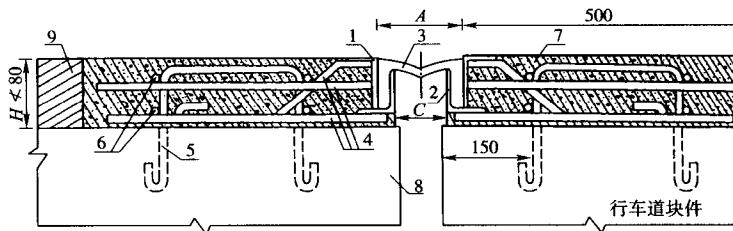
M 形橡胶伸缩装置构造示意图(尺寸单位:mm)
